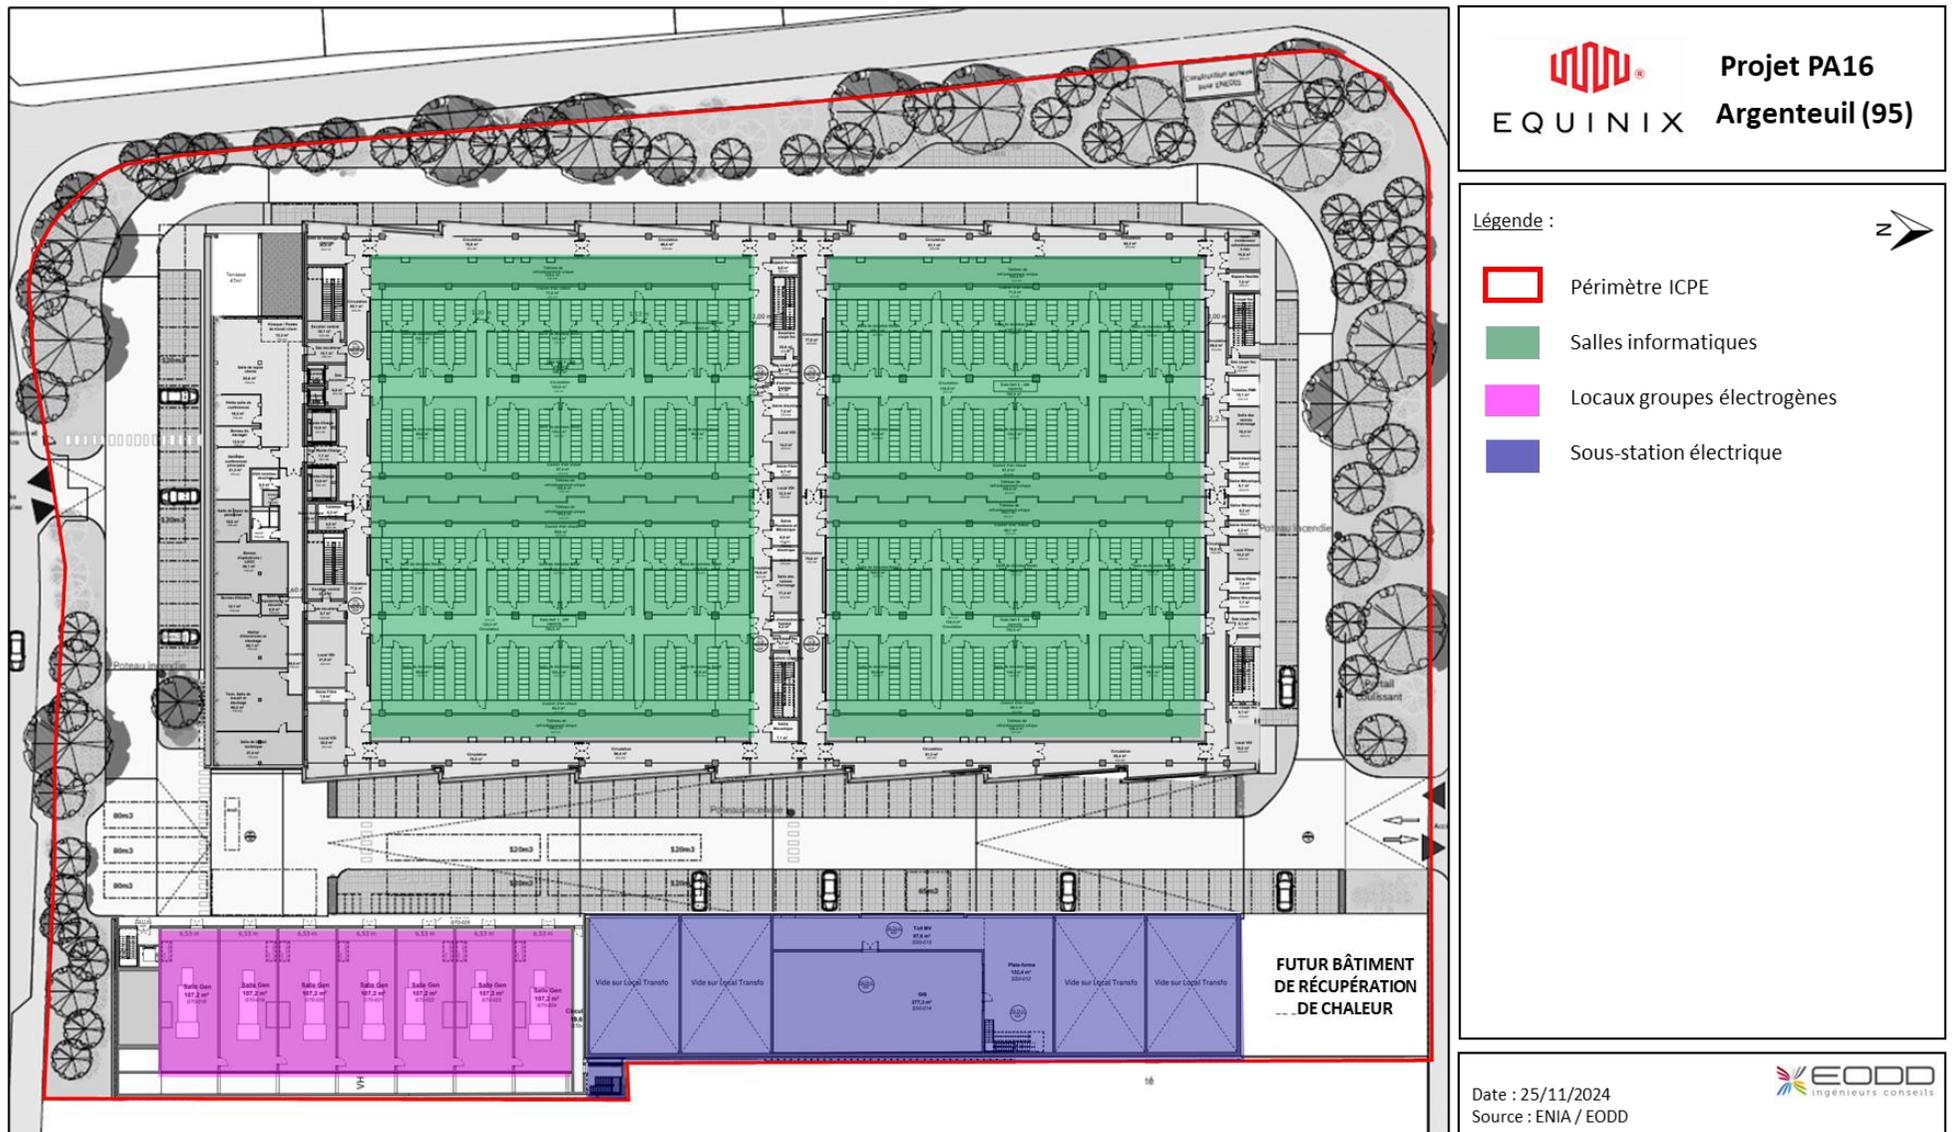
Localisation des installations principales du site projeté (niveau R+1)
